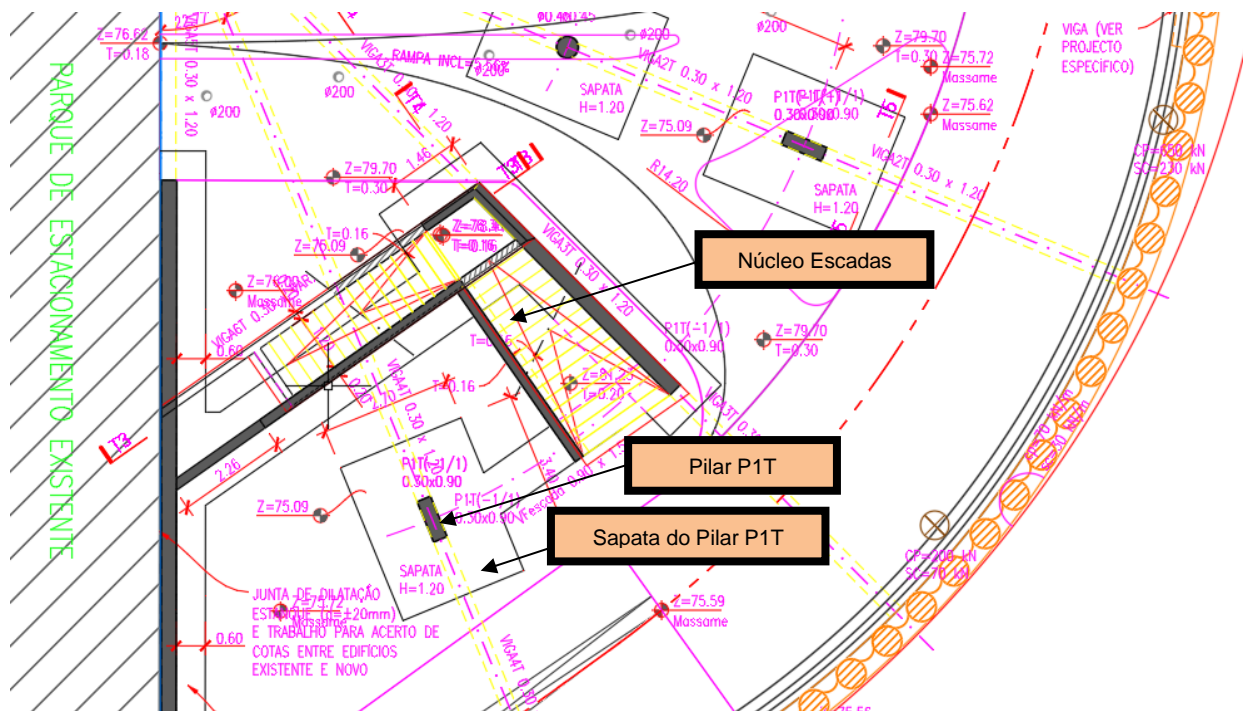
(adaptada de [15]): Planta da zona central do túnel onde foi instalada a sapata do pilar P1T
